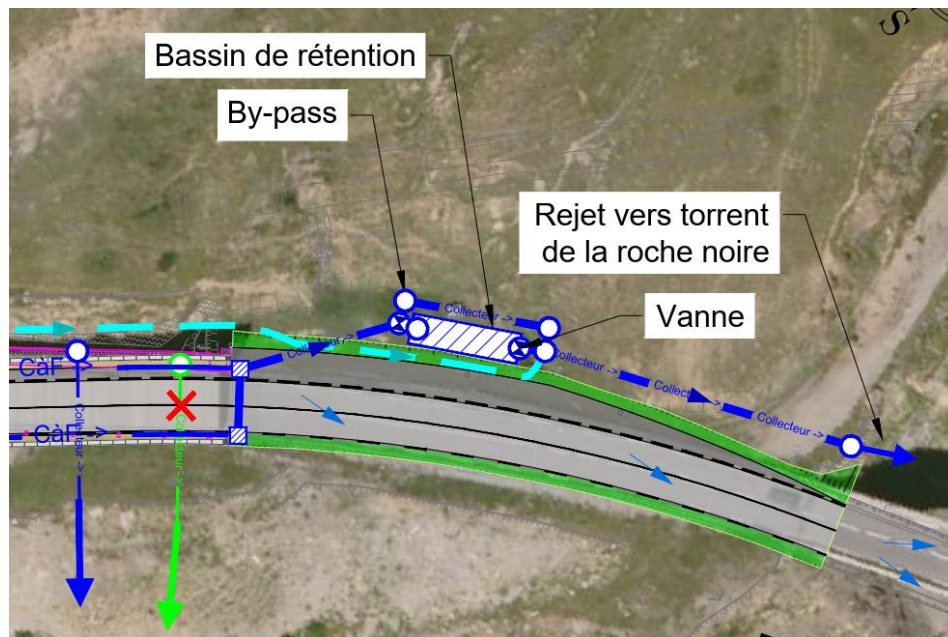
Vue en plan du système d'assainissement à l'aval de l'ouvrage côté Briançon
